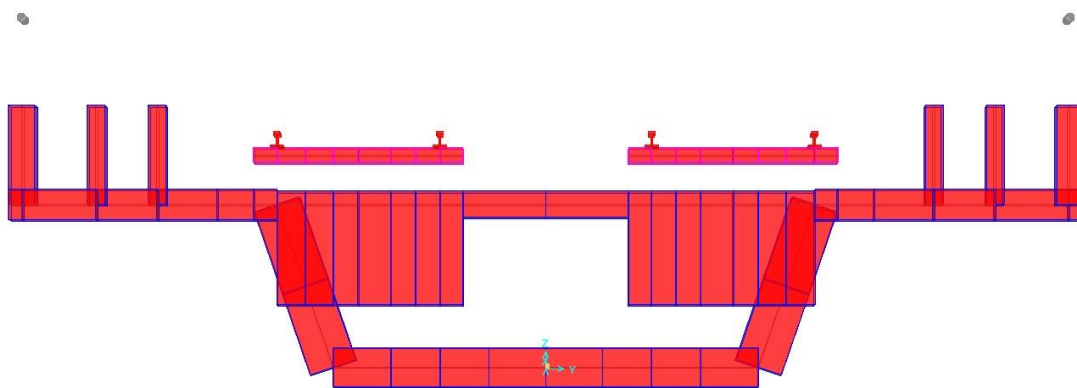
Secção transversal do tabuleiro na secção das zonas de transição
